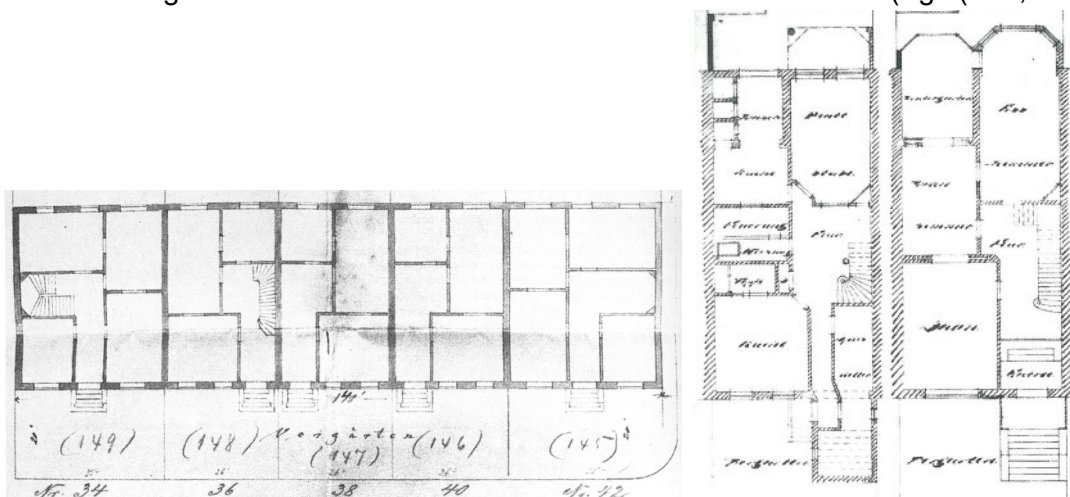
Grundrissbeispiele für ein frühes Bremer Haus im Ostertorviertel, Humboldtstraße 145 – 149, 1868, und ein tiefes Haus im Parkviertel, Parkstraße 58 – 62, 1890 (Die Sparkasse in Bremen, 1982)
